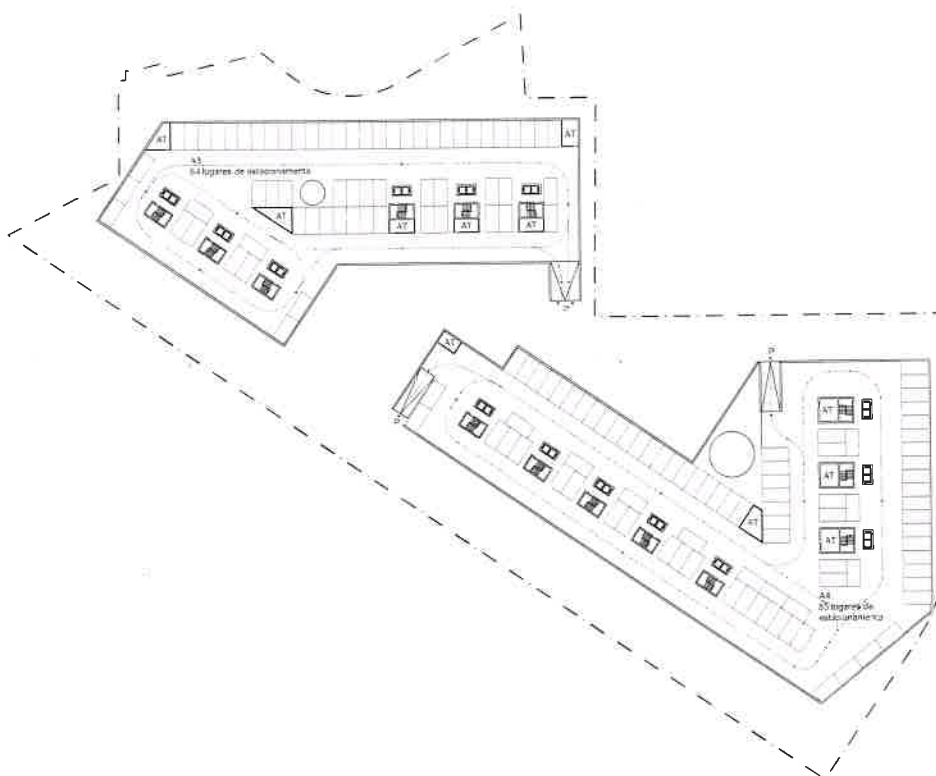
Planta do Piso enterrado (sem recuado), Proposta Claret&Brito Lda
